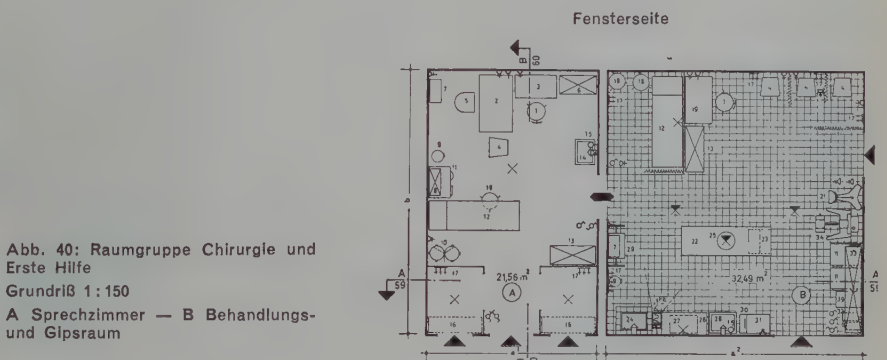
Raumgruppe Chirurgie und Erste Hilfe Grundriß 1:150
